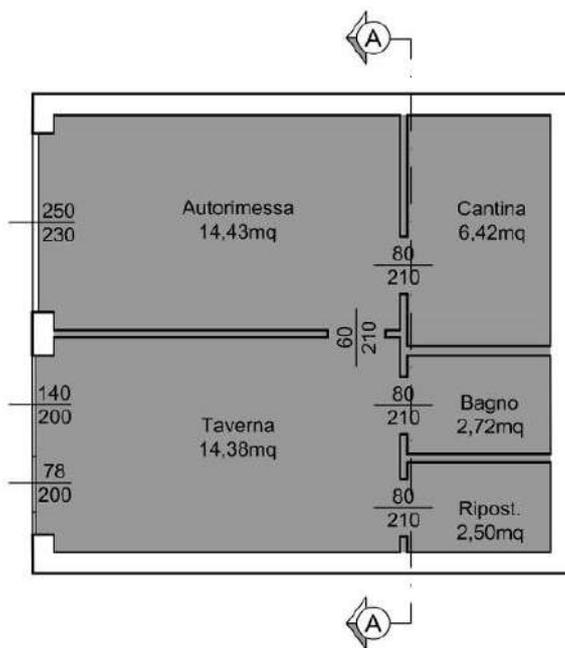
VARIANTE ALLA SCIA n°14755 del 13/12/2022 stralcio tavola di progetto in variante dell'autorimessa/taverna
